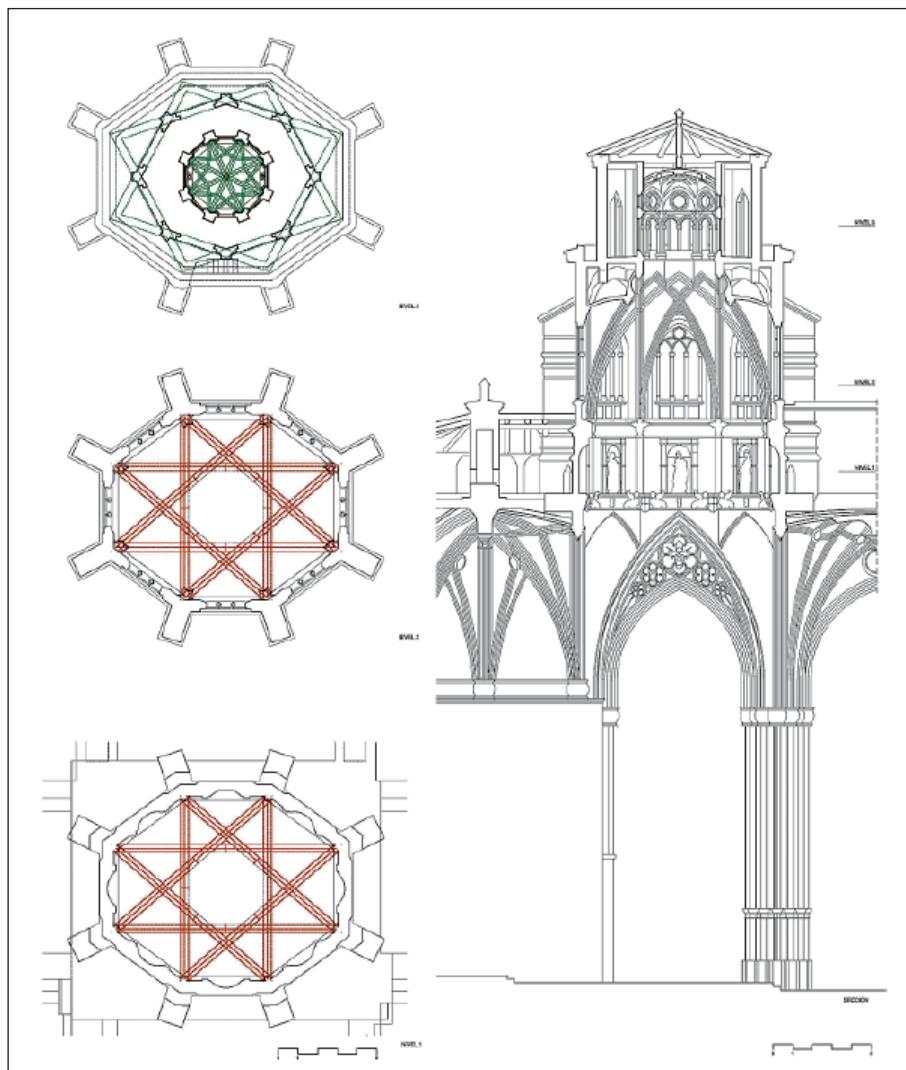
Plantas y sección del cimborrio de la seo de Zaragoza
